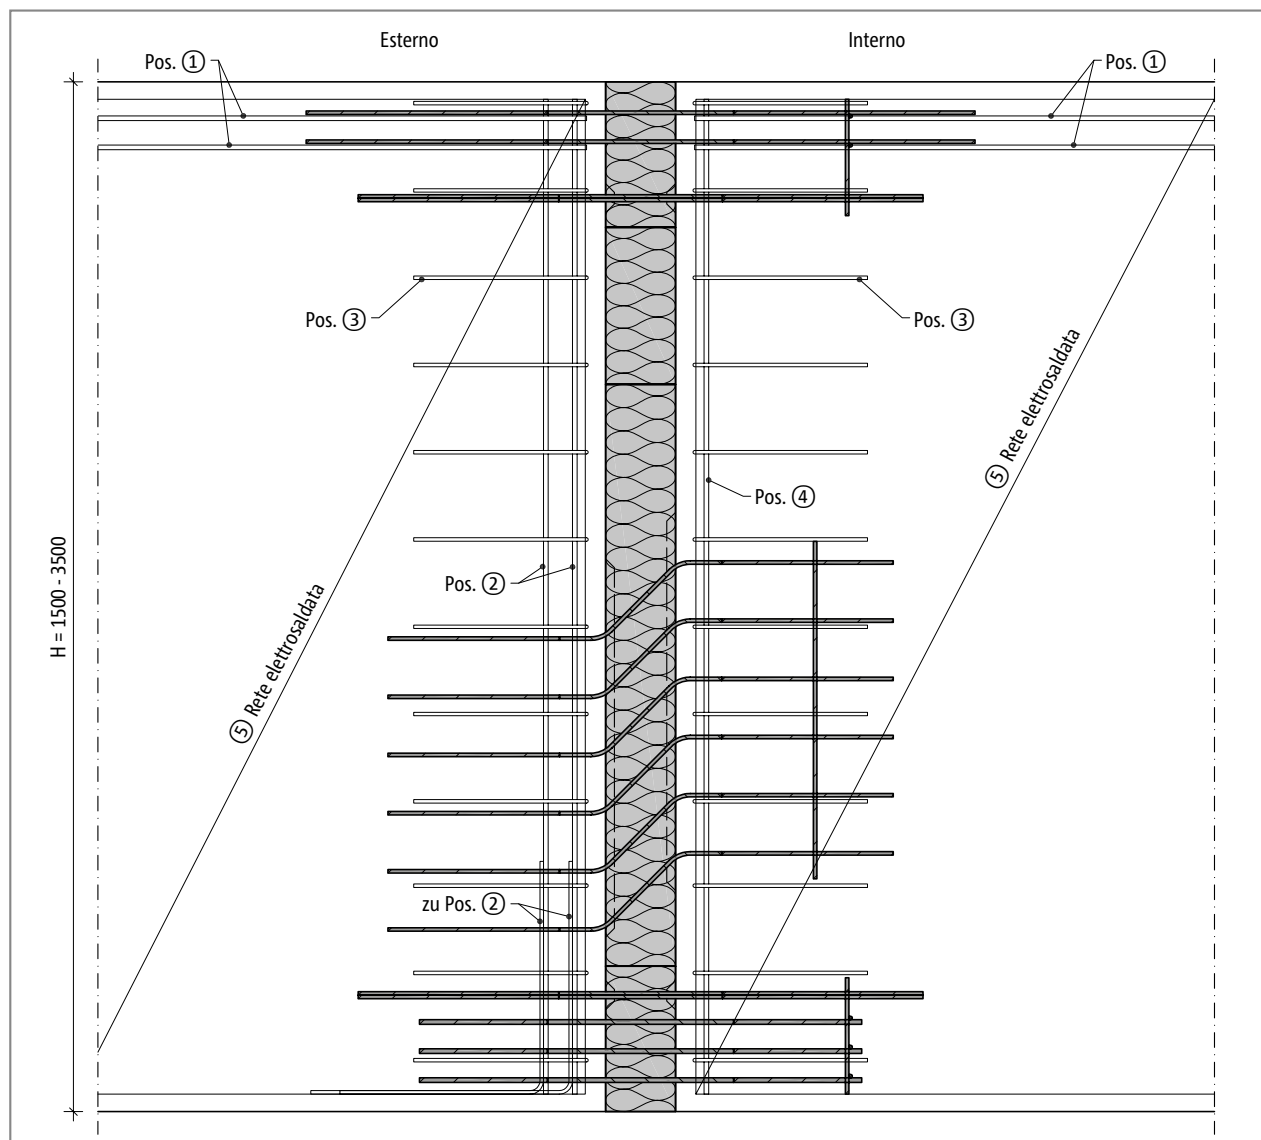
Schöck Isokorb® tipo WXT: armatura in opera; sezione
